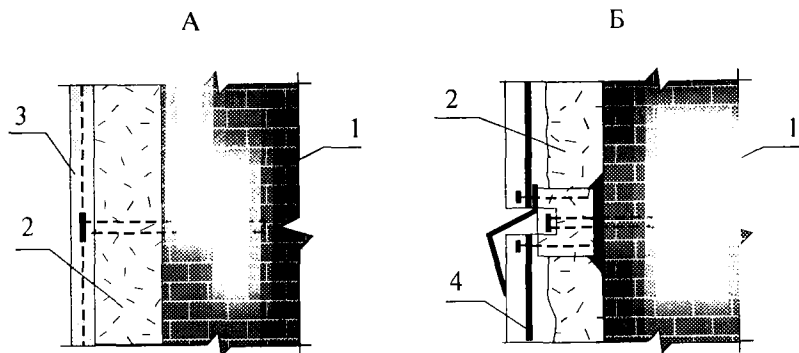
Варианты отделки фасадов при утеплении стен снаружи
